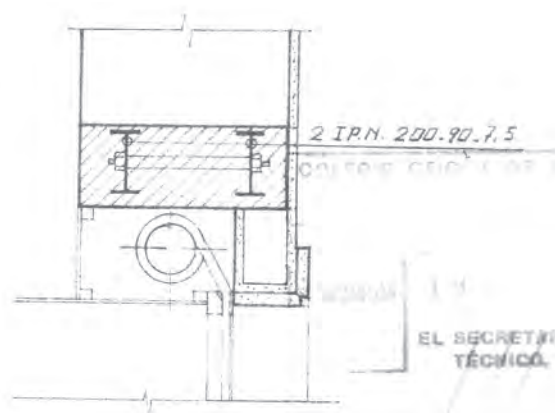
32. DETALLE DEL CARGADERO PROPUESTO²⁹
